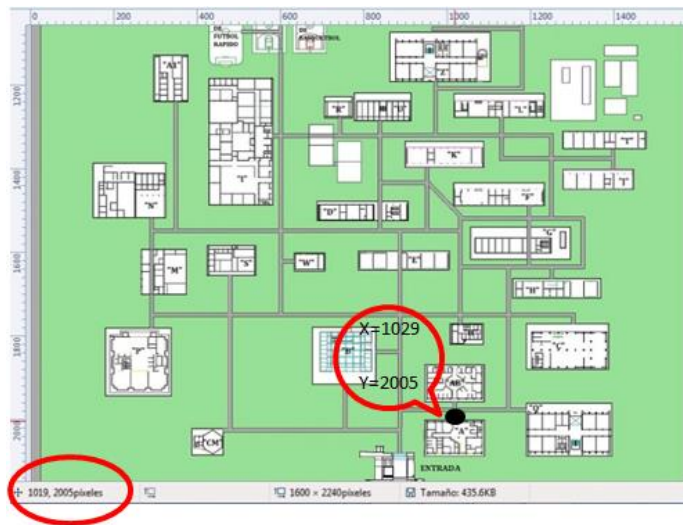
Plano arquitectónico digitalizado en términos de píxeles para la aplicación del I. T. de Tuxtla Gutiérrez.
